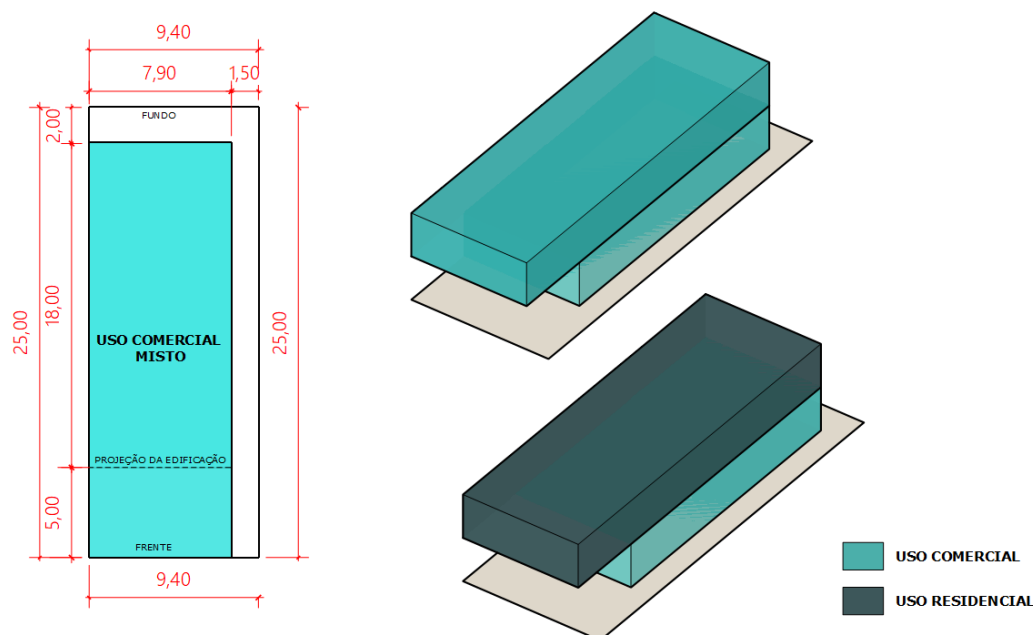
Lote Comercial com Fachada Ativa Opção 1
